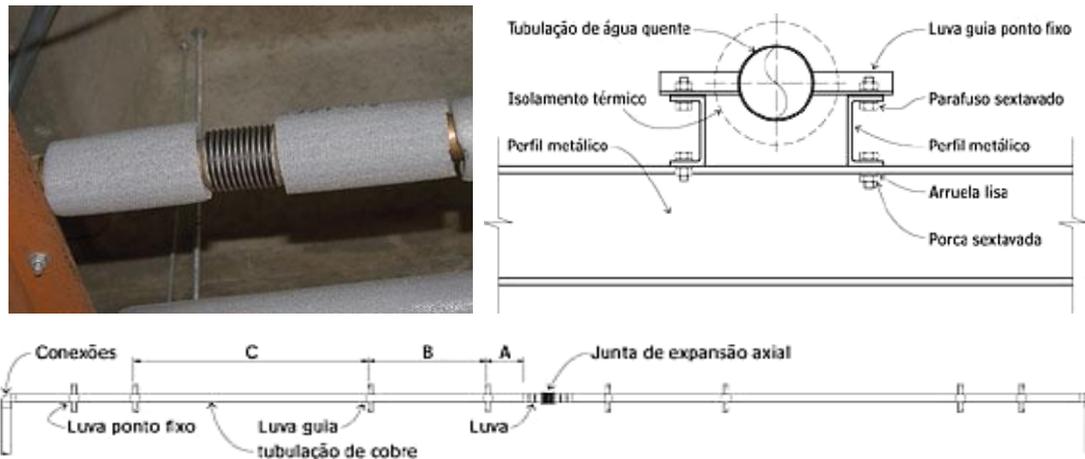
Junta de expansão em cobre do SPAQ sob laje, com respectivo detalhamento para produção.
